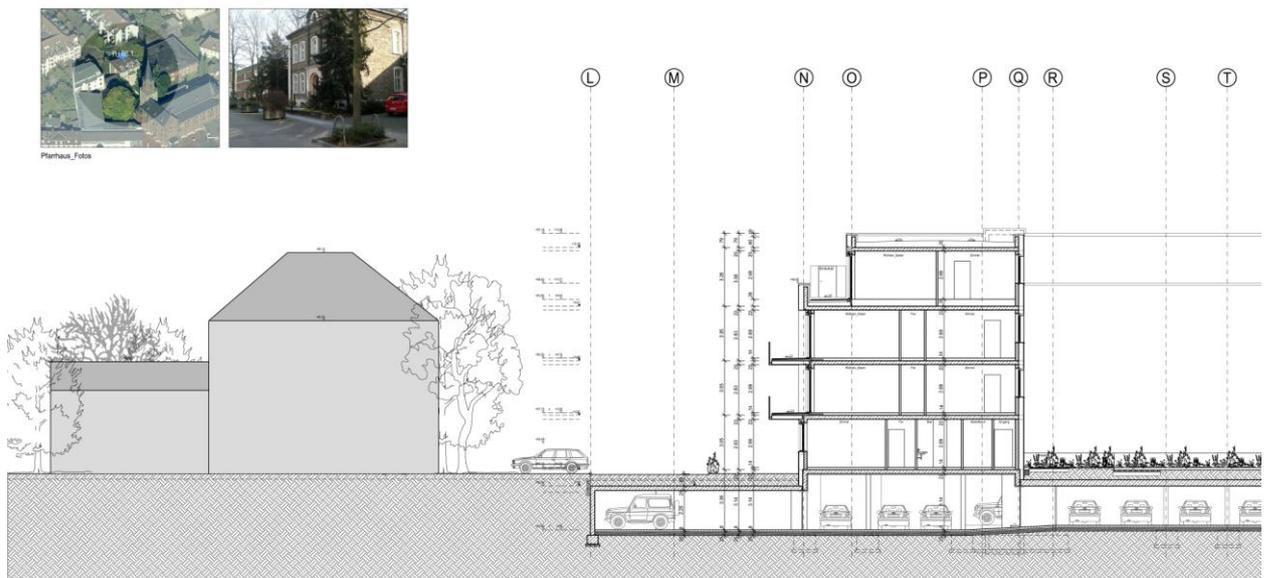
Schnitt Pfarrhaus und angrenzende geplante Wohnbebauung.
